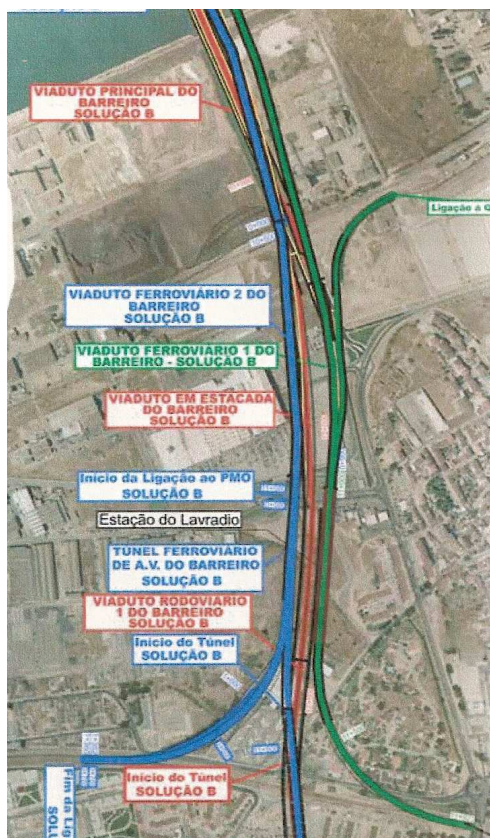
Ponte Chelas-Barreiro (RAVE) - Acessos no Barreiro- Planta
